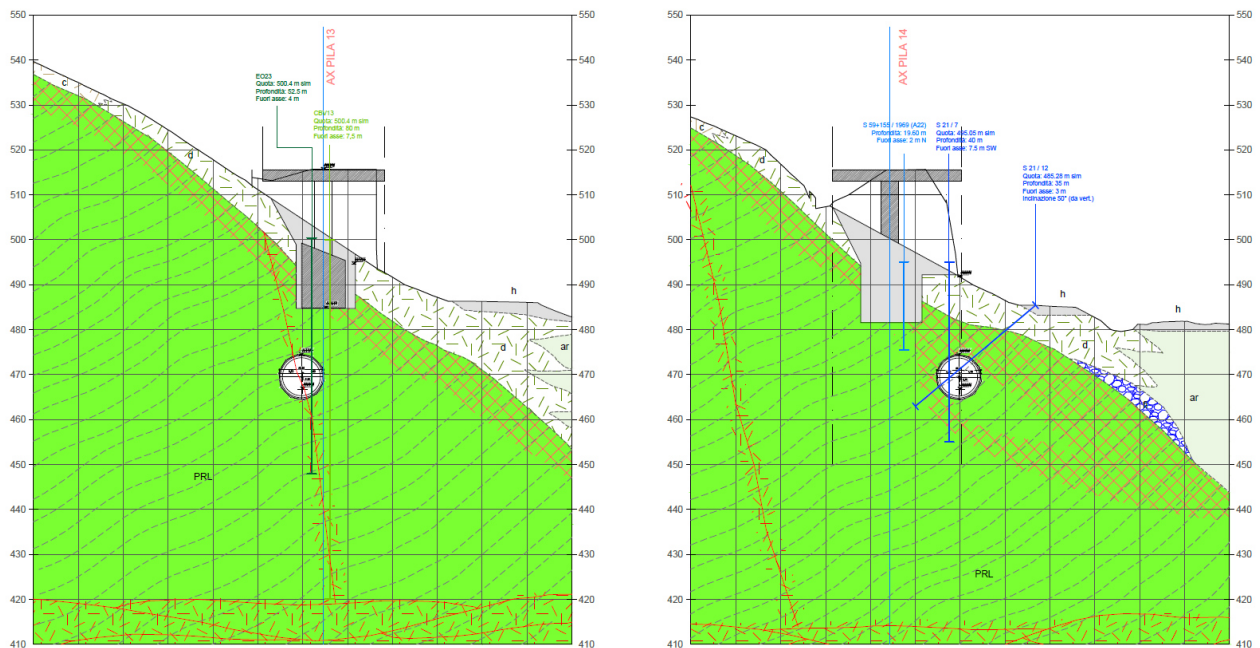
Stralcio del planoprofilo di dettaglio dell'imbotto binario pari con le due sezioni trasversali all'altezza delle pile 13 e 14 del viadotto Belprato (o Novale) dell'A22 - elaborato IBOU1BEZZL7GE0001005B.
